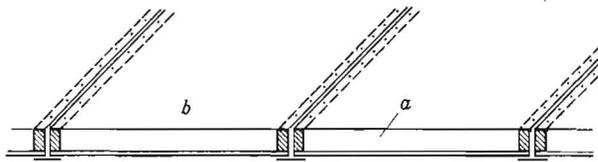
Deckentafeln im Einbauzustand. a Wärmedämmschicht, b Packpapier
